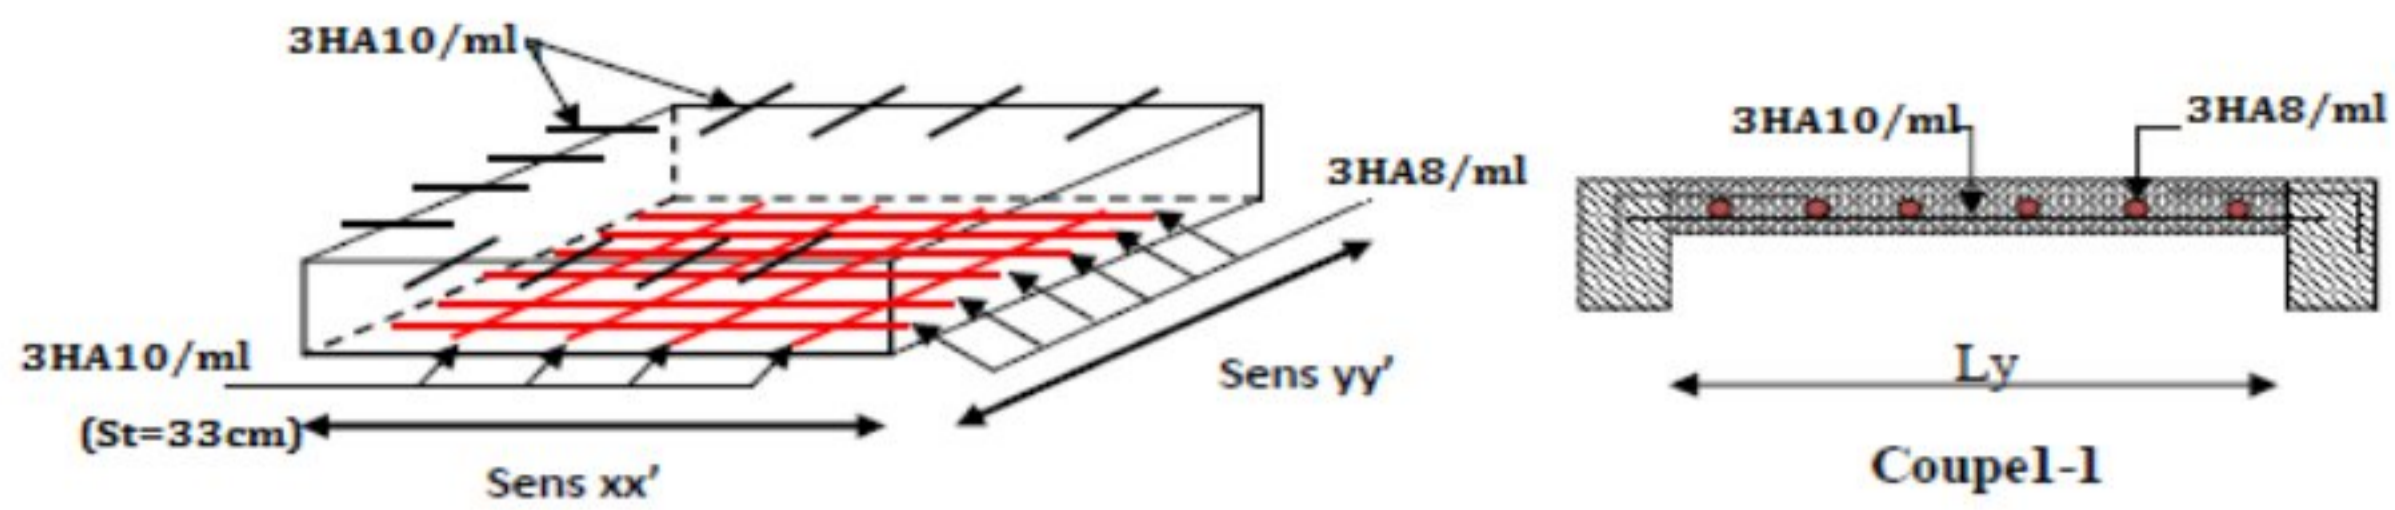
Schéma de ferrailage de la dalle sur 3 appuis
